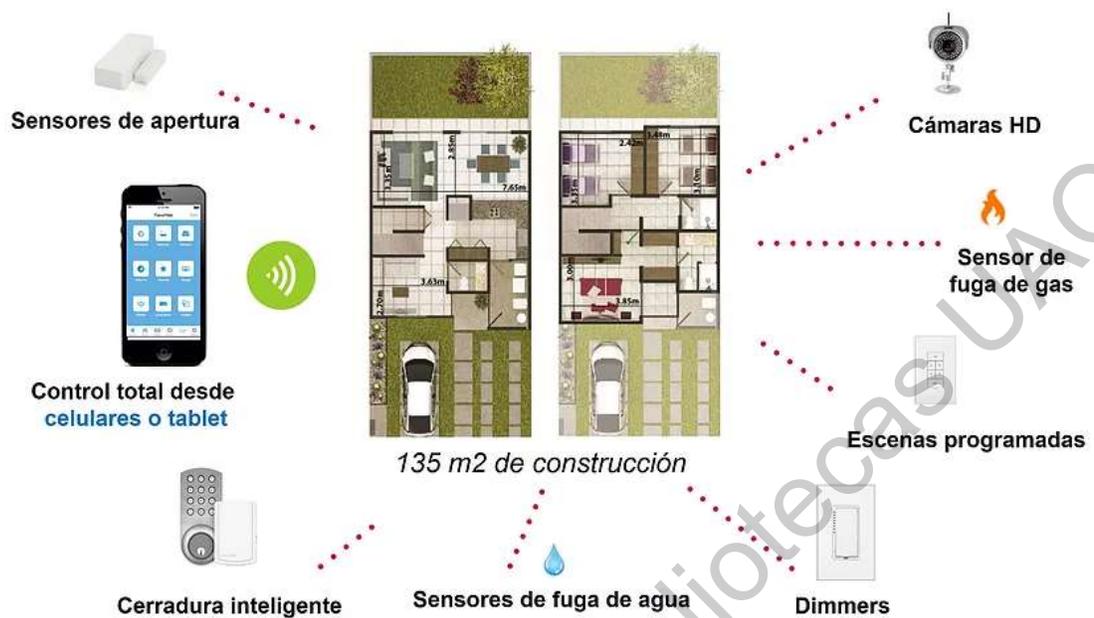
Primer escenario de automatización en vivienda de 135m2 de construcción.
